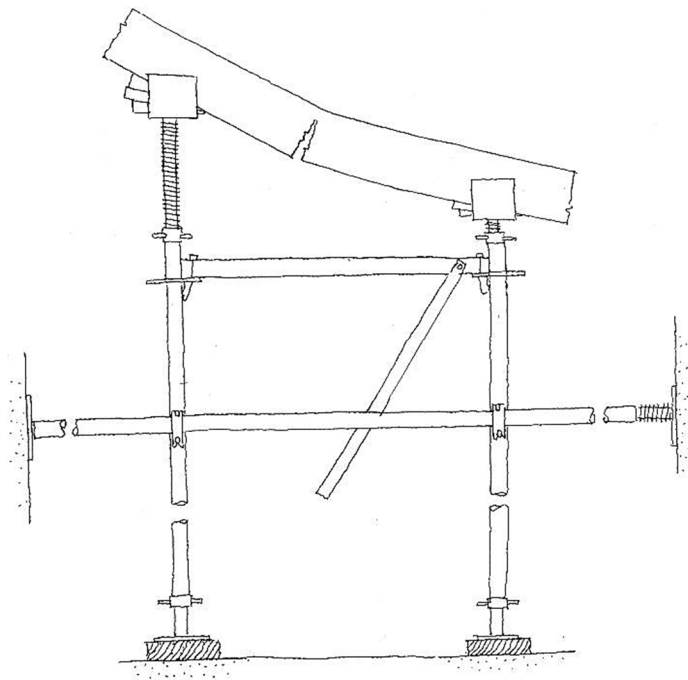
Apuntalamiento de par dañado mediante estructura tubular
